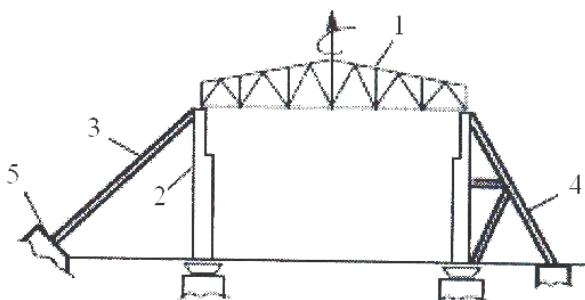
Пример усиления стропильной фермы установкой наружных подпорок и оттяжек:
